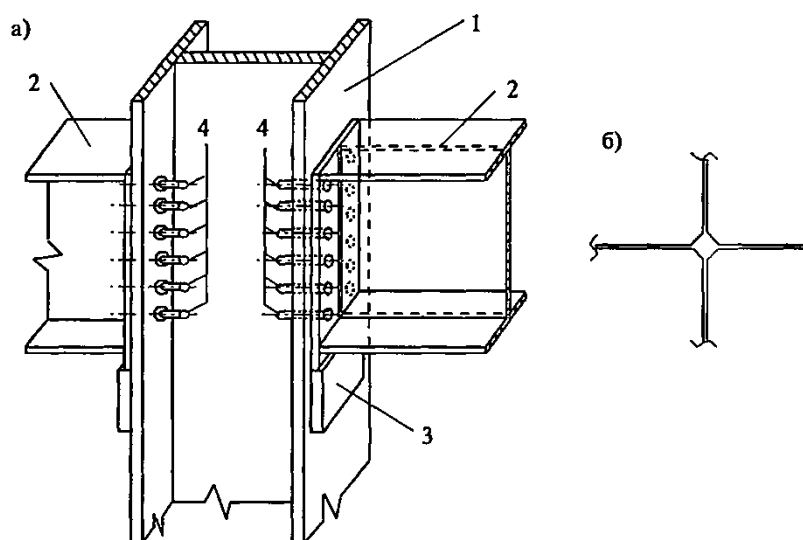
Жесткое прикрепление балок к стальной колонне сбоку: а) схема опирания балок; б) расчетная схема сопряжения колонны и балок; 1 — колонна; 2 — балки; 3 — опорный столик колонны; 4 — болты (гайки и головки болтов не показаны)
